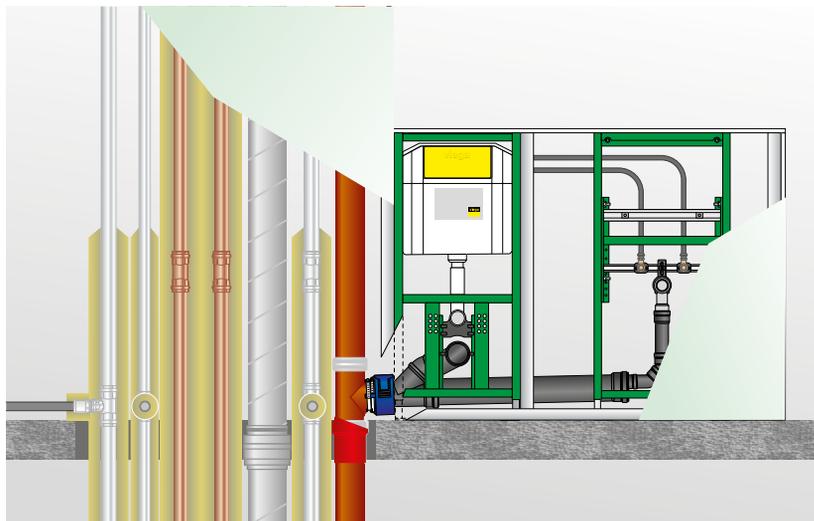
Schachtaufbau mit Guss SML Abwasserleitungen in Mischinstallation
